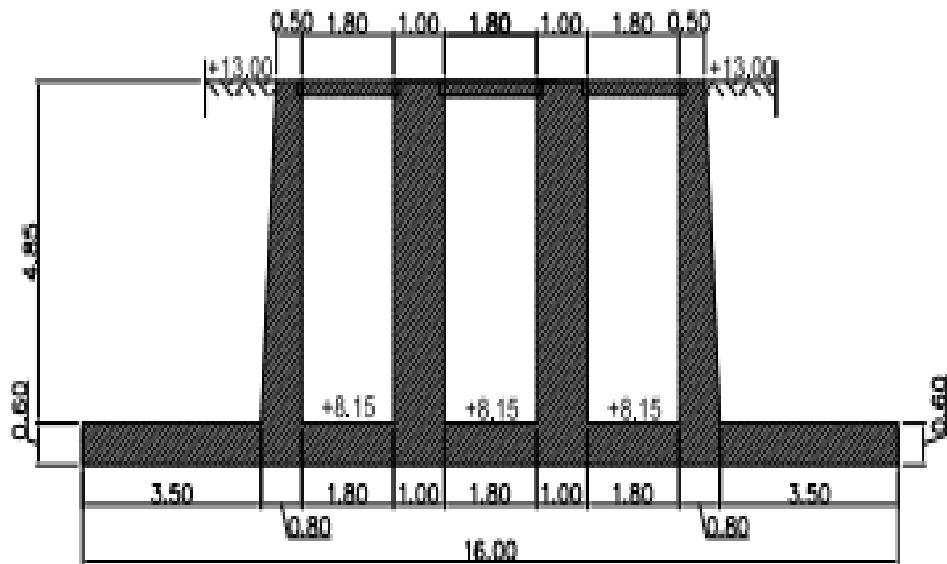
Denah Bendung (DED Bendung Sei Wampu)
